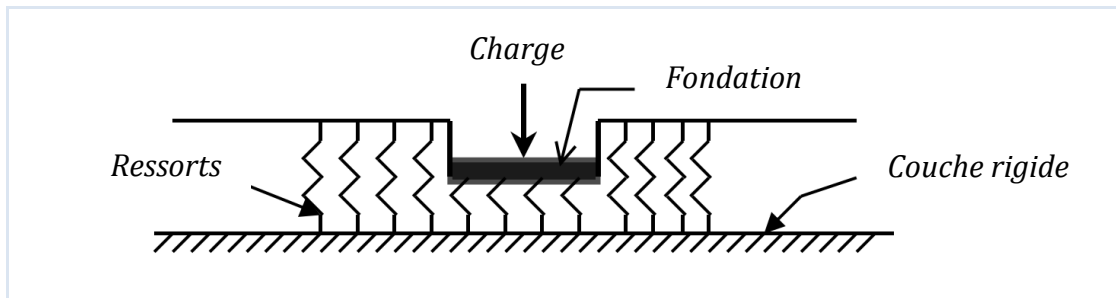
Fondation de Winkler [Dutta SC, 2002].
